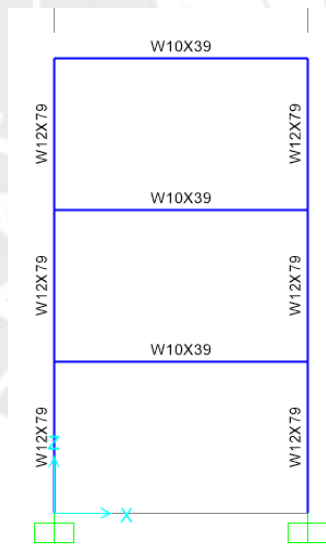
Pórtico de tres niveles con viga con apoyos simples
